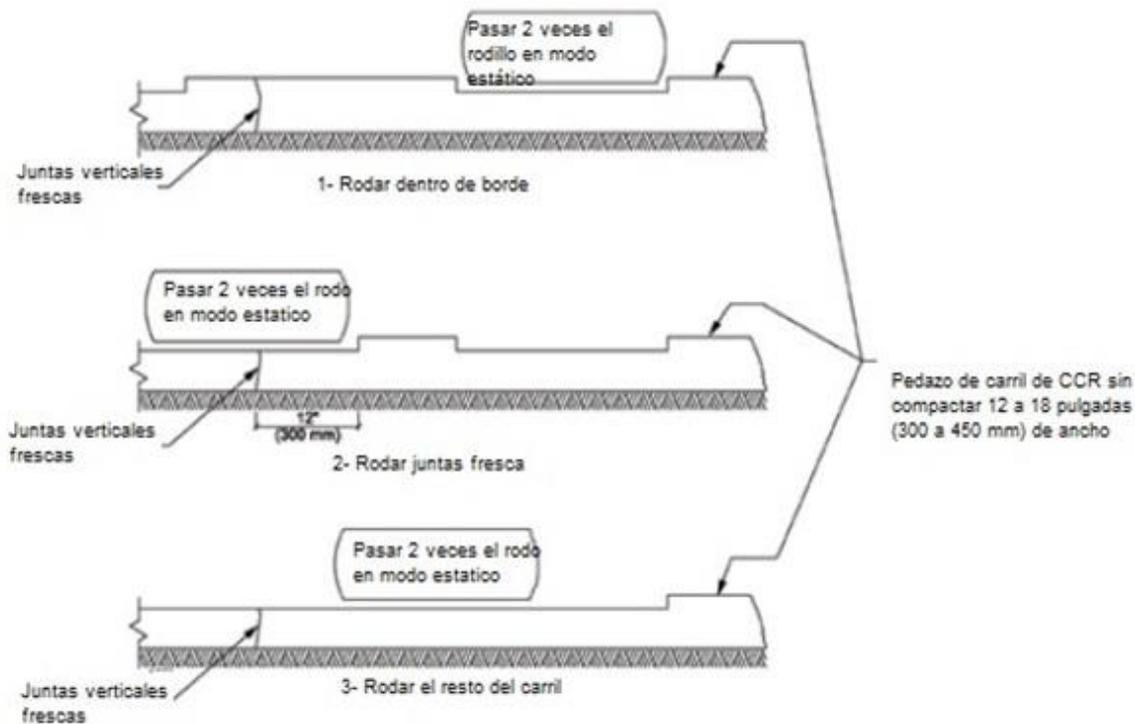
proceso junta longitudinal fresca en pavimento de concreto compactado con rodillo
